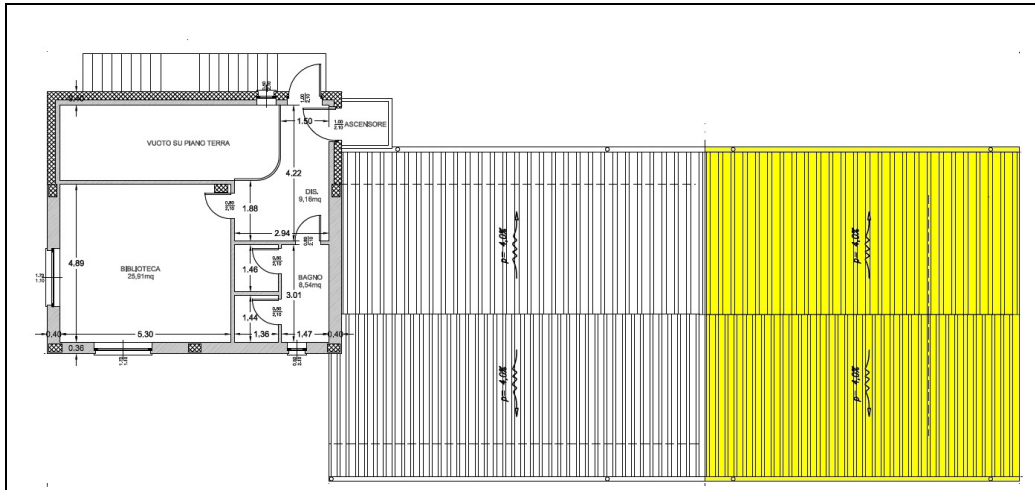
Progetto: pianta del piano primo (tratta dalla Tavola n. 5)
